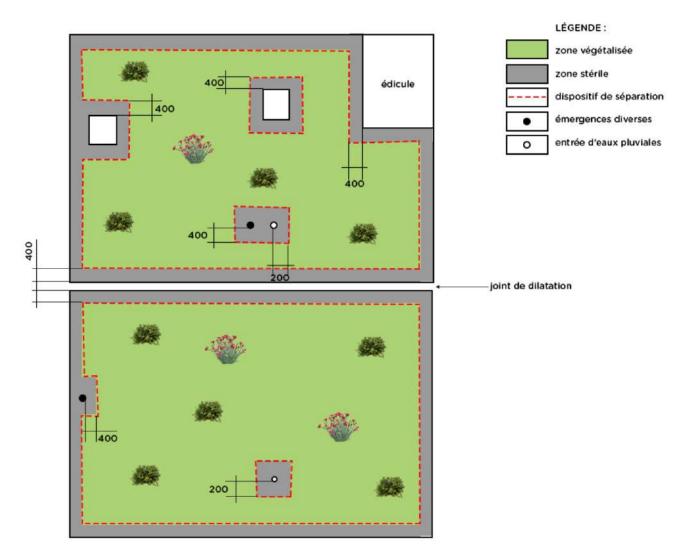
Zones stériles des toitures terrasses végétalisées inaccessibles sauf pour l'entretien
